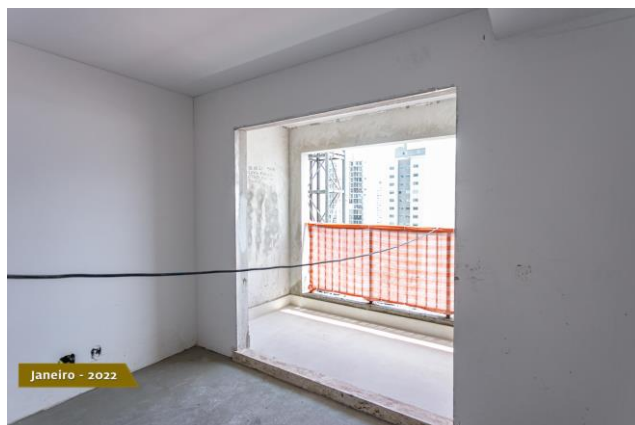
Paredes com acabamento de massa corrida, contrapiso de pavimento e piso de varanda colocado.
